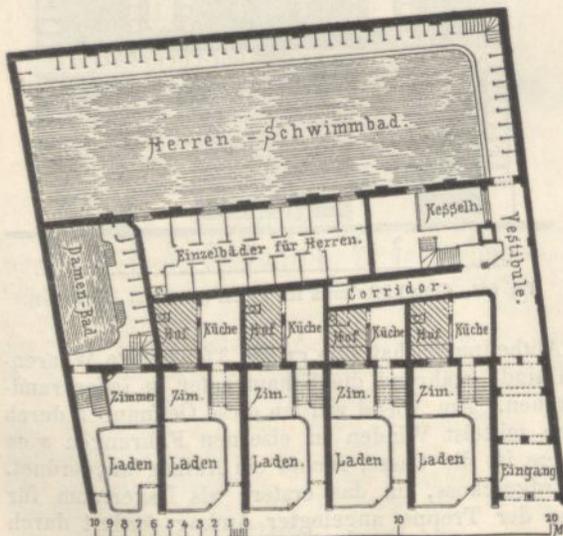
Badeanstalt in Finsbury Park (Architekt J. J. Bennet).
